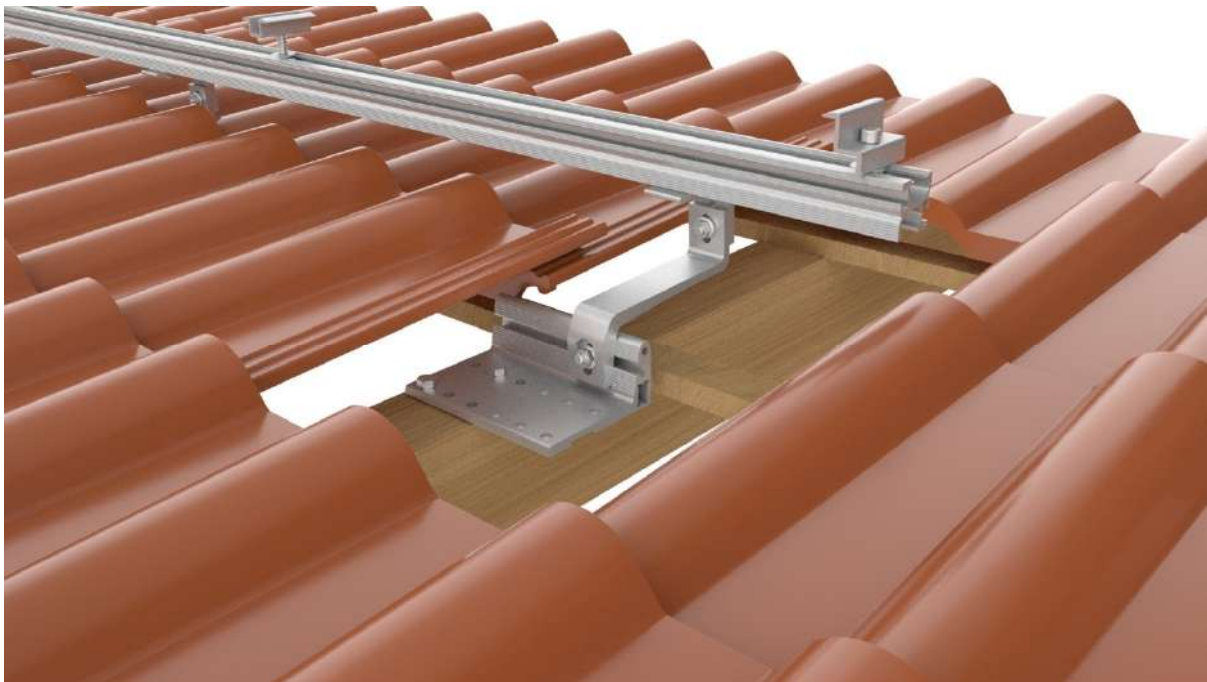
Soluzione per tetto con tegole – fissaggio staffa gancio HE-STA-150
